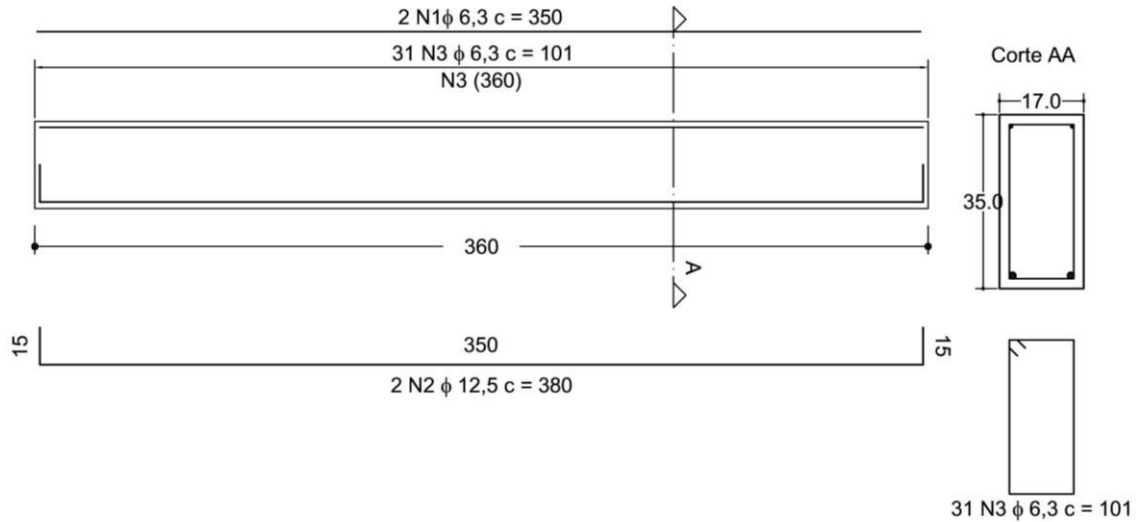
Configuração de carregamento e geometria de todas as vigas de Ferrari
